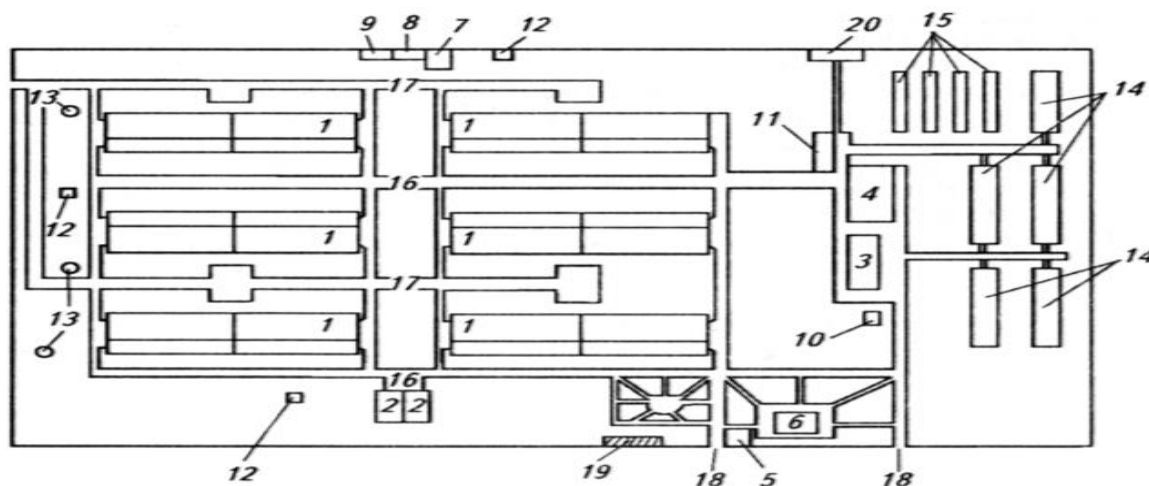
Генеральний план кроликоферми на 1800 основних маток
